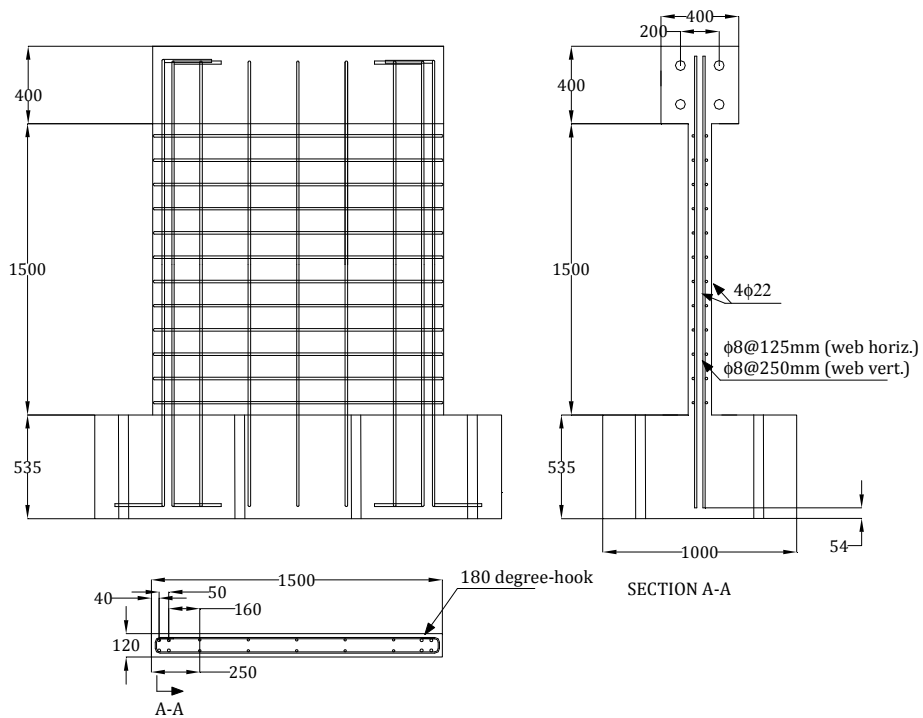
Geometría y detalle de armadura de muro Tipo 5
